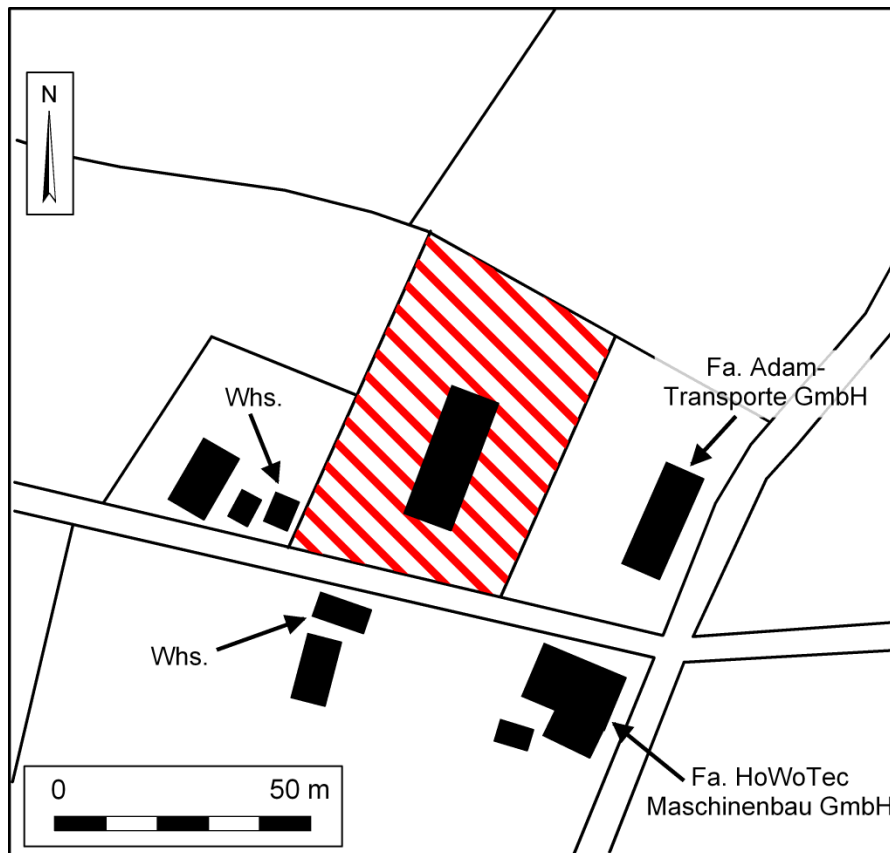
Lageplan des Betriebsgeländes (rot schraffiert) und der umgebenden Gebäude.
